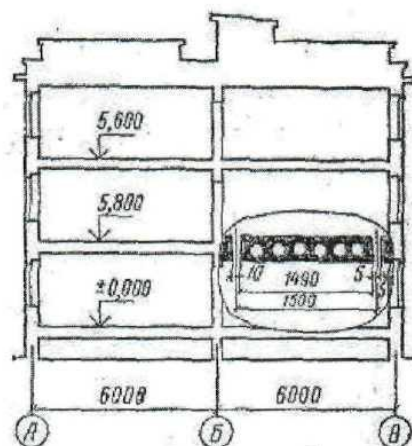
Разрез здания с укладкой панелей сборного перекрытия
